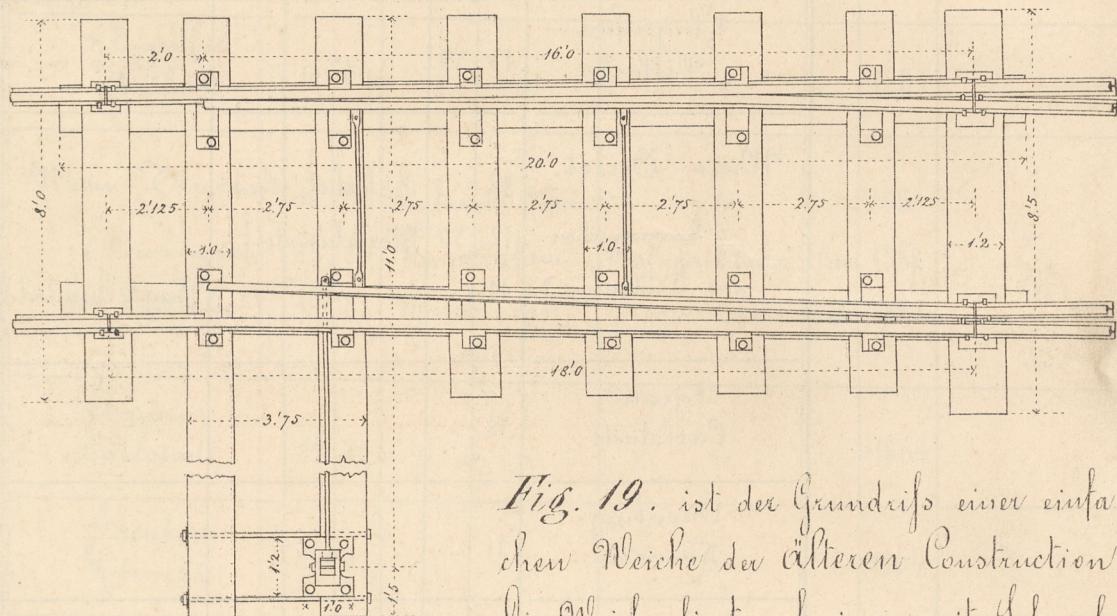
ist der Grundriss einer einfachen Weiche der älteren Construction. Die Weiche liegt auf einem mit Schraubenbolzen verbundenen Holzrost. Die gusseisernen Schienenstöfe, und die Ausrückständer sind ebenfalls mit Schraubenbolzen auf den Holzrost befestigt.
